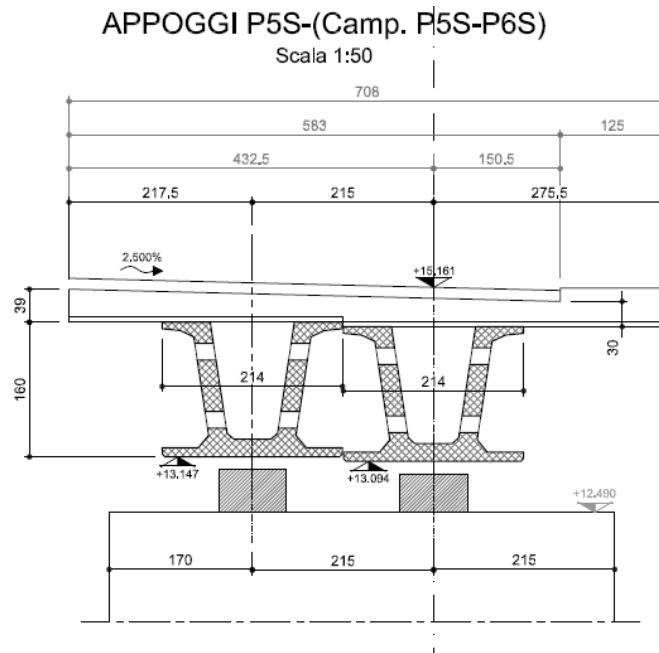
Sezione trasversale Campata 6 (a 2 travi) – Rampa S – P5_S
